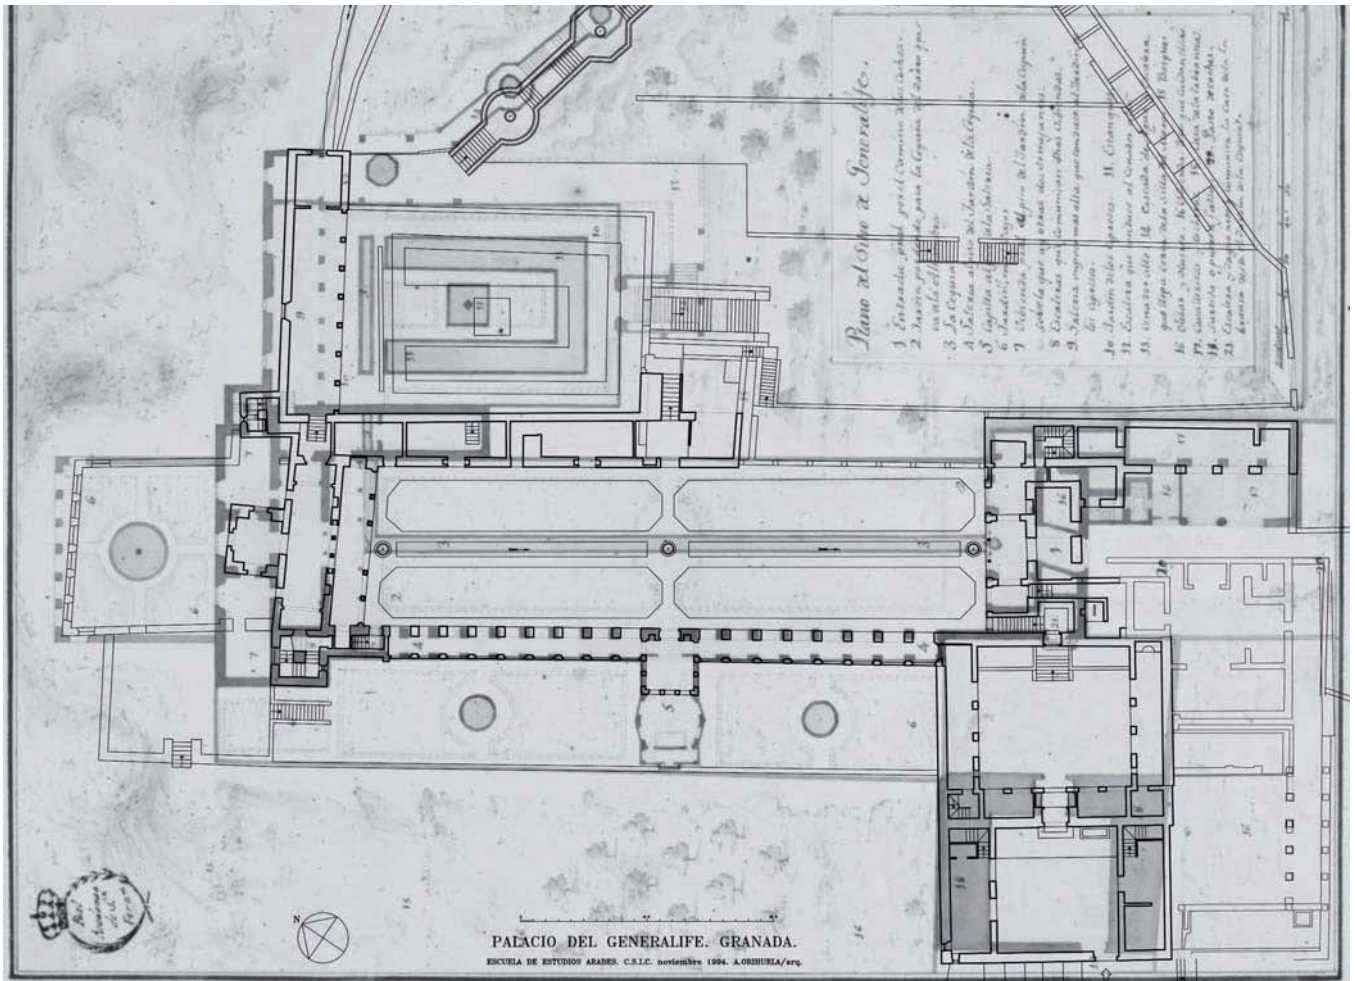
Sovrapposizione della pianta del Generalife di Hermosilla con una planimetria moderna.
